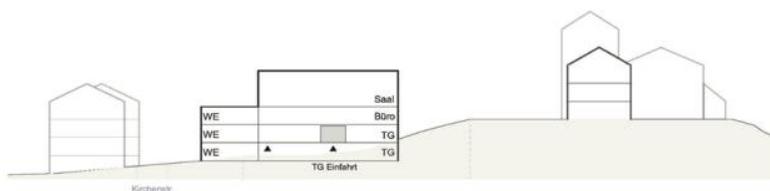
Schemaschnitt Nord-Süd - Variante 1 (ohne Massstab)
